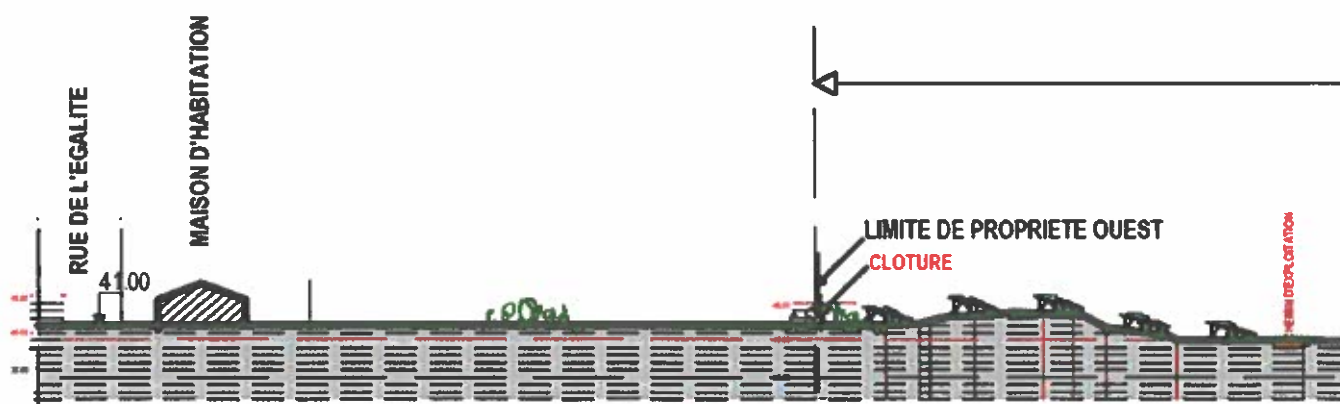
Plan de coupe zoomé Ouest-Est (un masque végétal existe en limite de site, au niveau de la clôture)
